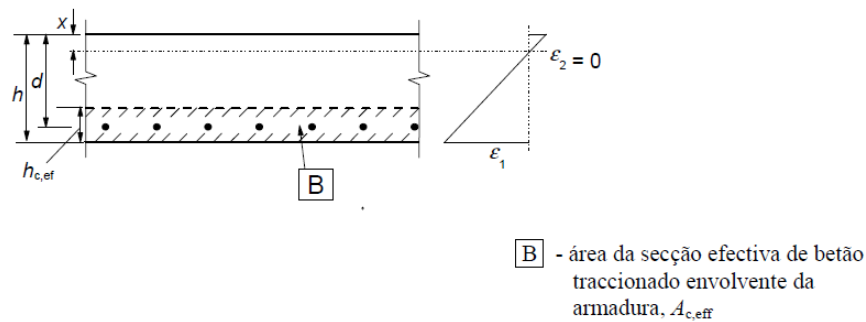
Secção efetiva de betão tracionada da laje [13]
